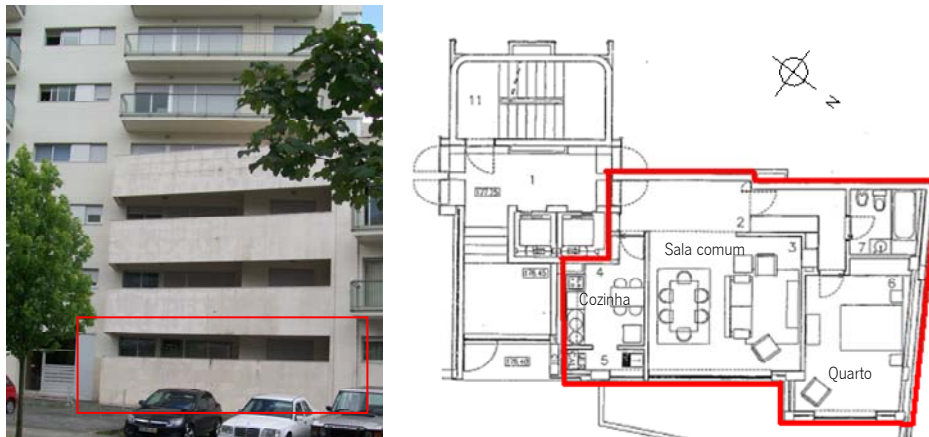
Alçado principal e planta da Habitação 7.1
